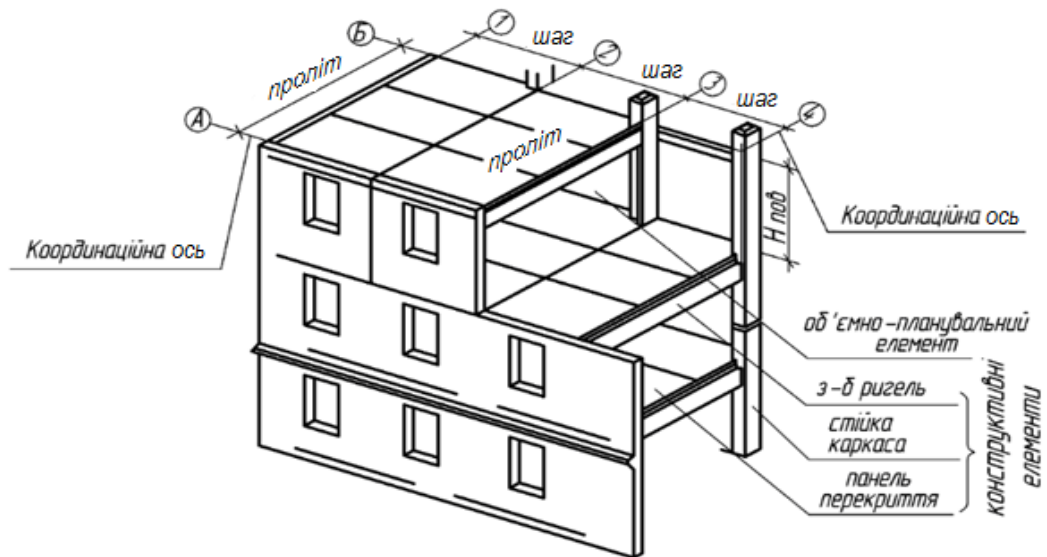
Конструктивні і об'ємно-планувальні елементи багатоповерхової будівлі
